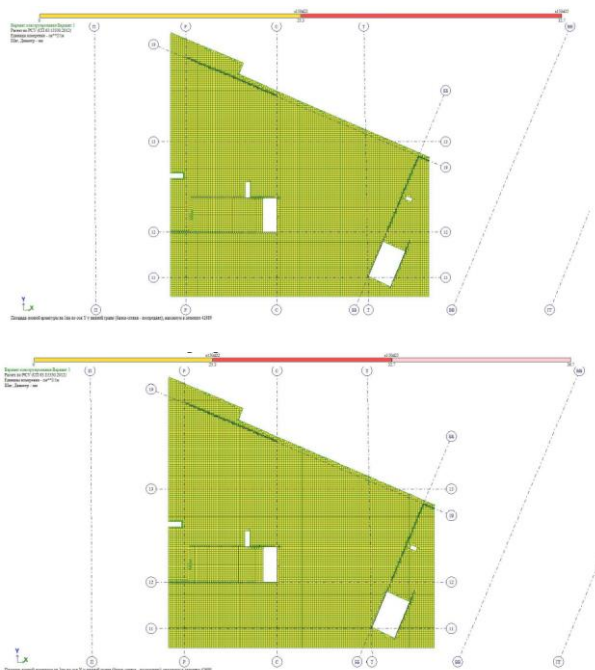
Площадь поперечного сечения нижней арматуры вдоль цифровых и буквенных осей (по X и по Y).
